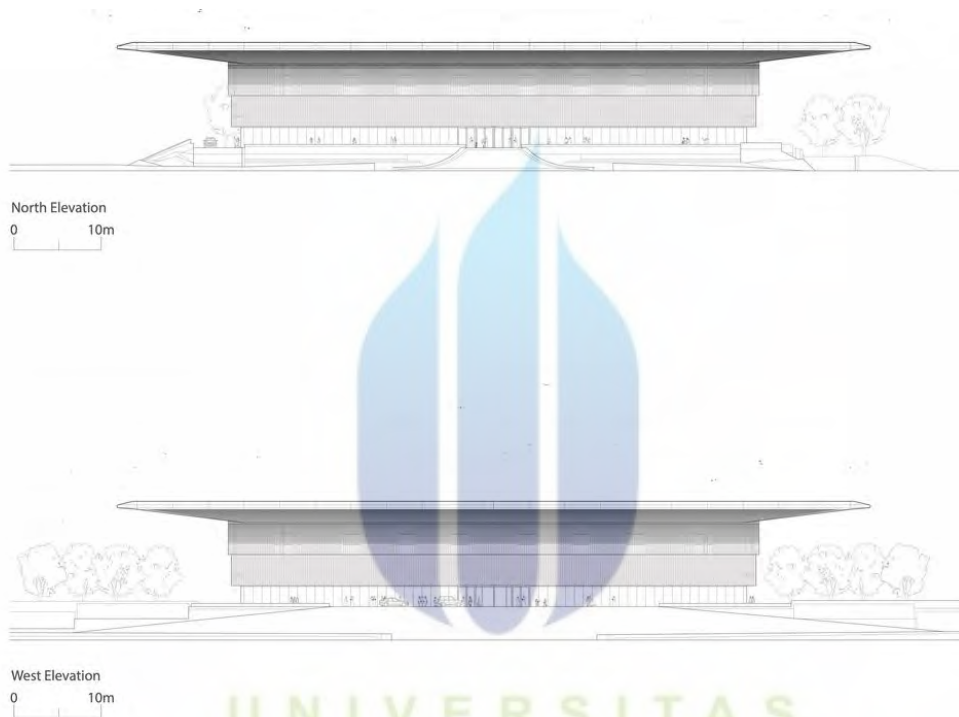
Facad Gedung utama Sumber <https://www.archdaily.com>
